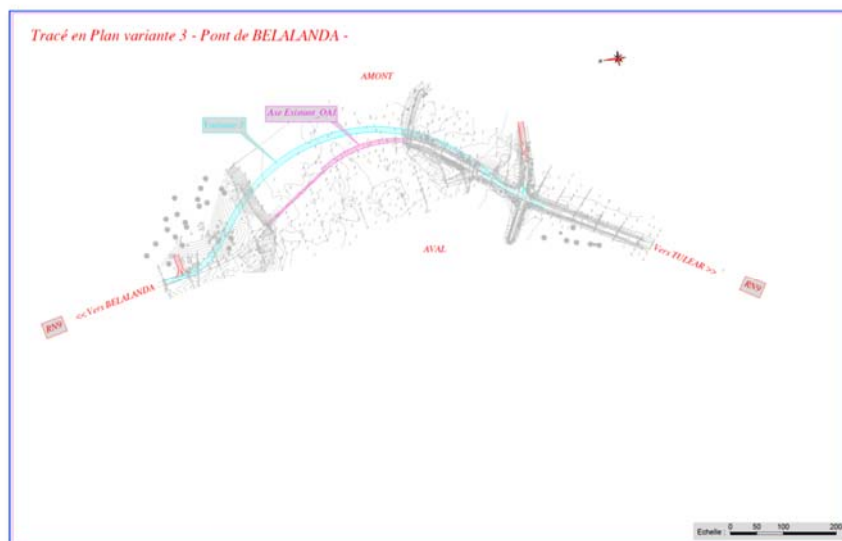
Tracé en plan de la variante 3 du pont de Belalanda
